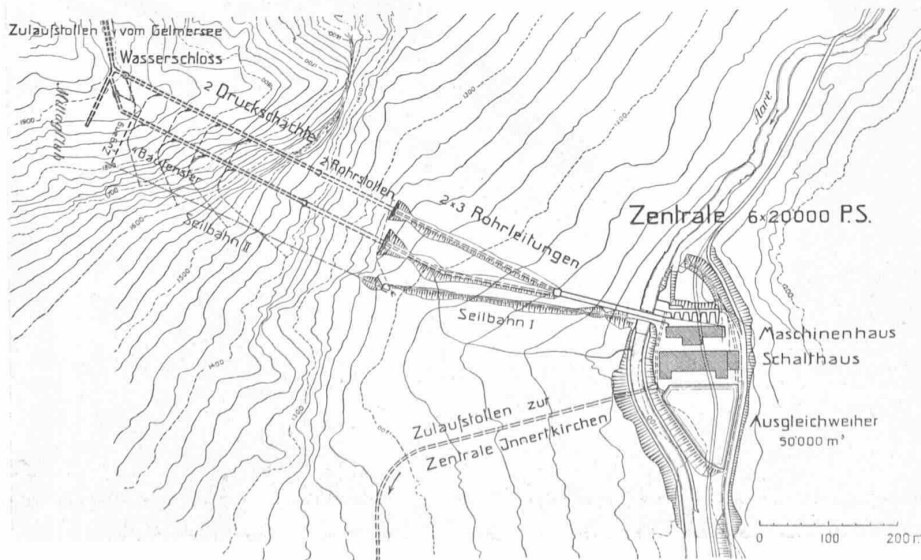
Situationsplan des Kraftwerkes Guttannen. — Masstab 1:10 000.
